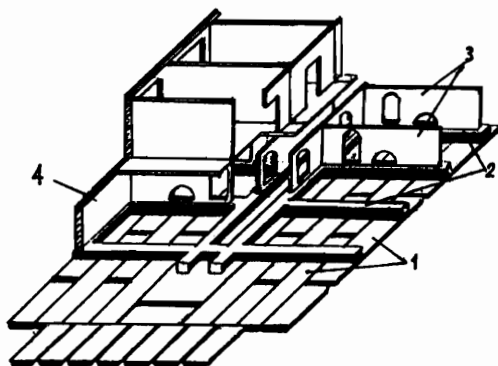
Сборная железобетонная фундаментная плита для многоэтажных крупнопанельных зданий: 1 - фундаментные плиты; 2 - распределительный пояс; 3, 4 - панели продольной и поперечной внутренних стен подземной части; 5 - панели перекрытия
